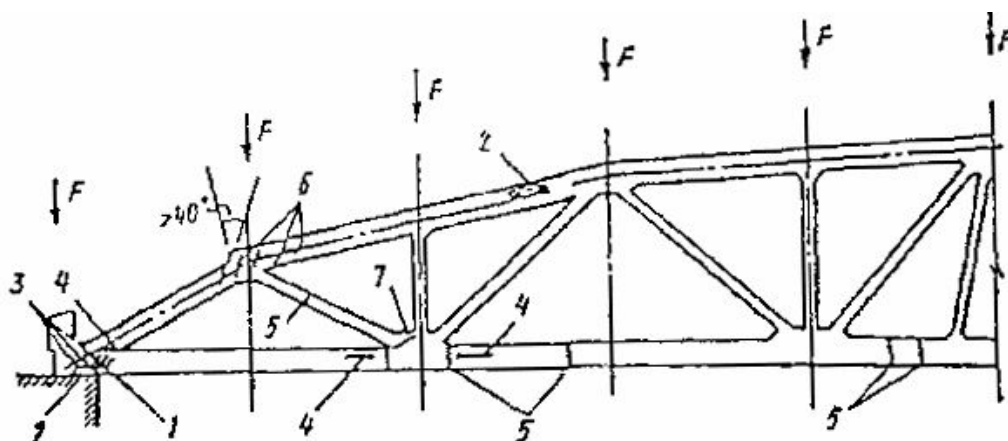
Характерные повреждения силового происхождения в железобетонных фермах с нижним предварительно напряженным поясом
